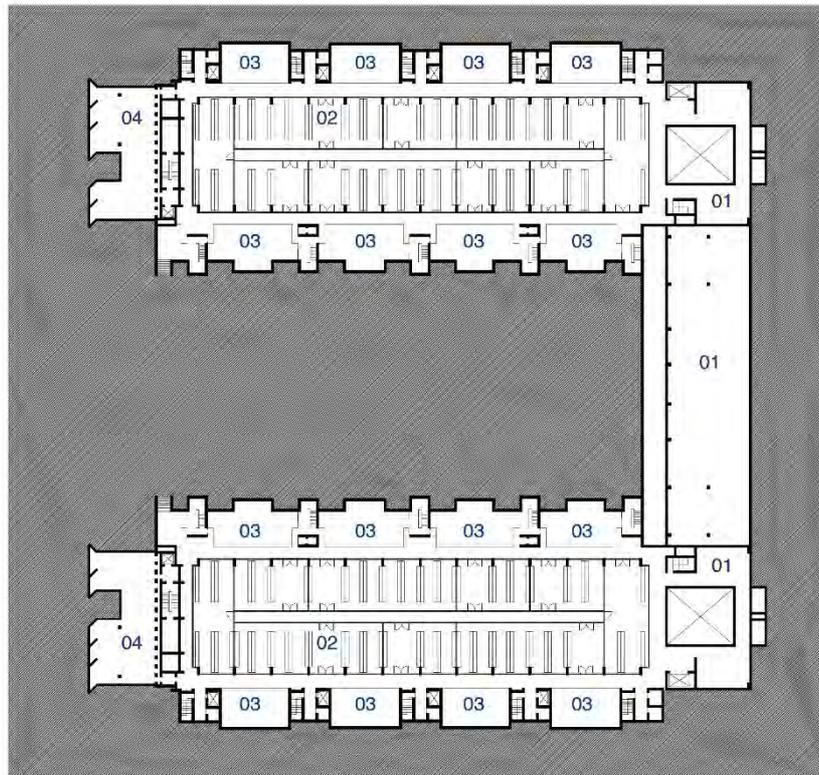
| Planta nível -2 (LABORATÓRIOS SUBSOLO) [redesenho do autor]
